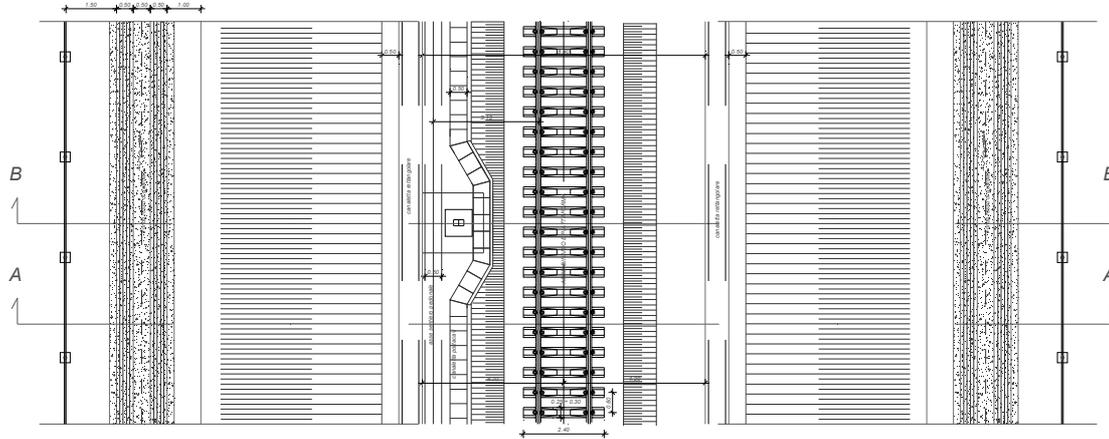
Stralcio planimetrico con sezione tipo ferroviaria in trincea a singolo binario in rettilio
